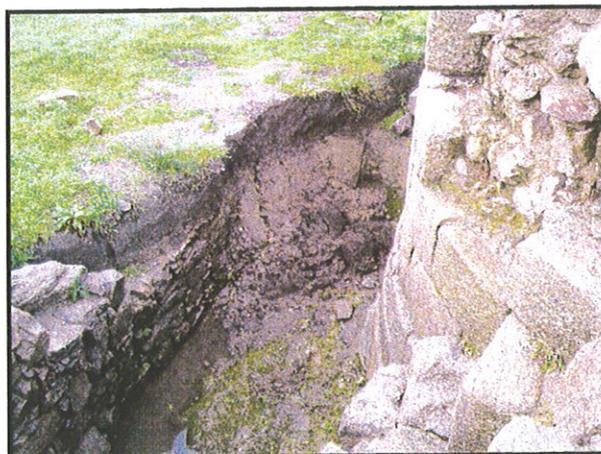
El mismo perfil tras las lluvias caídas en otoño de 2006.
